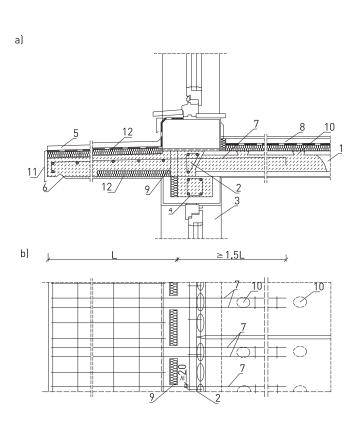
Соединение балконной плиты из армированного обычного тяжелого бетона с перекрытием
